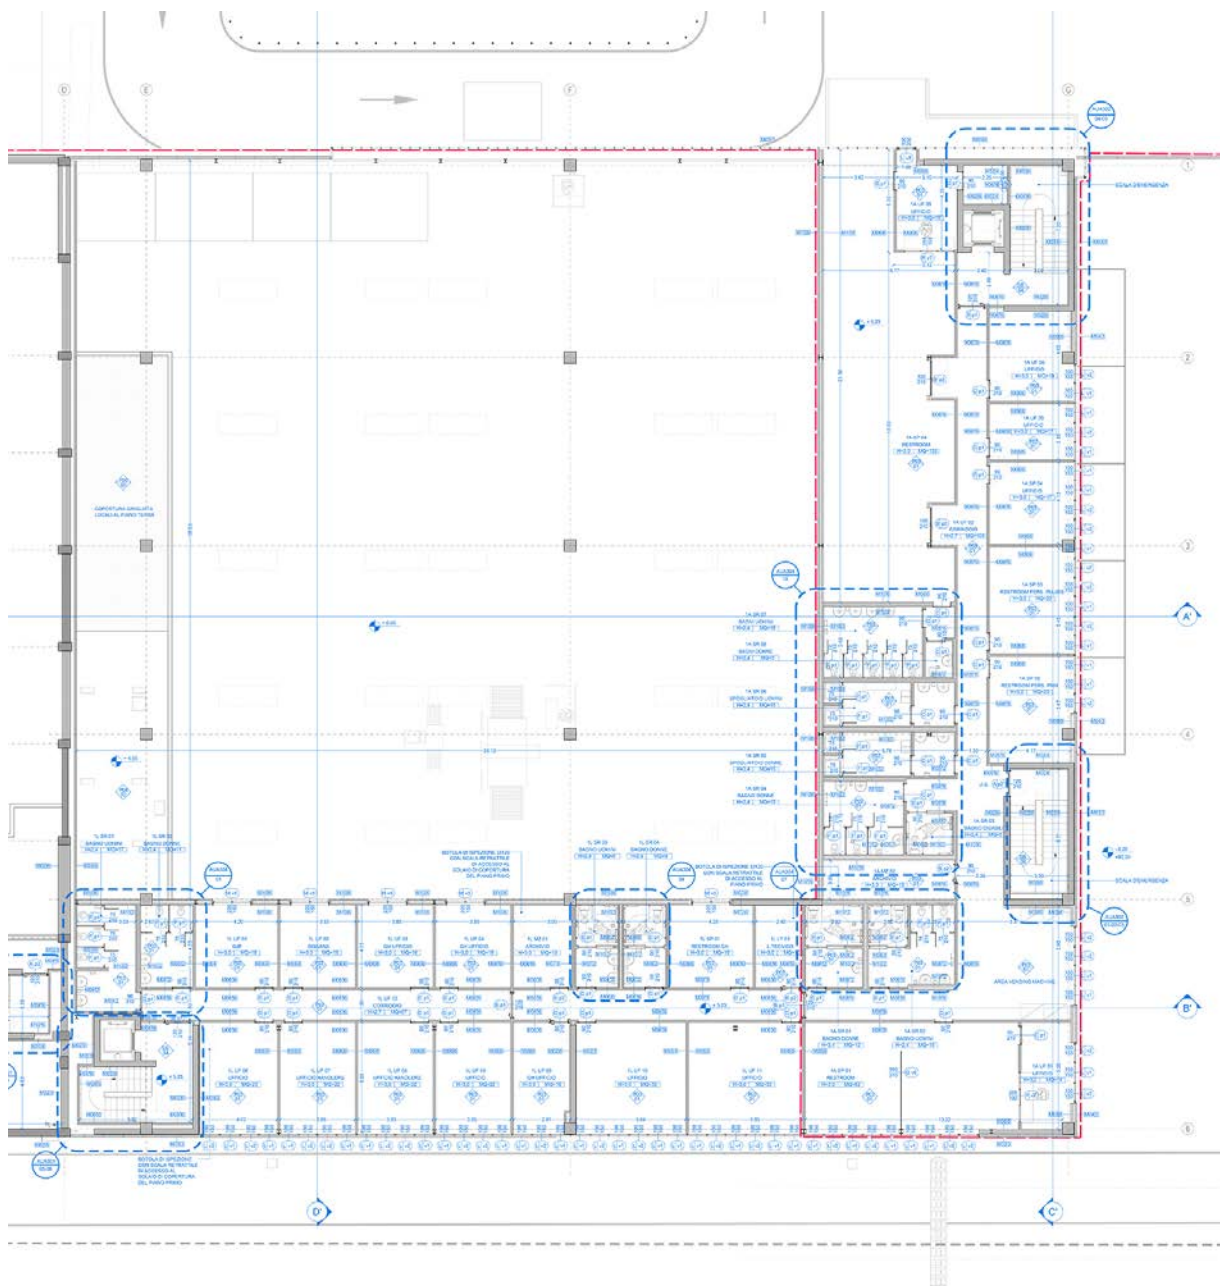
Stato di progetto – Pianta Piano Primo Terminal Mercati
